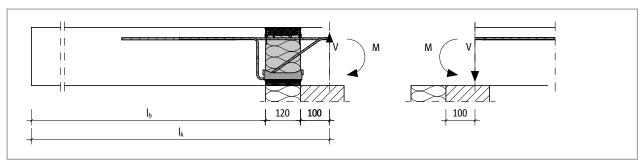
Schöck Isokorb® XT tipo K: Esfuerzos internos determinados en cálculo aplicados a la losa
